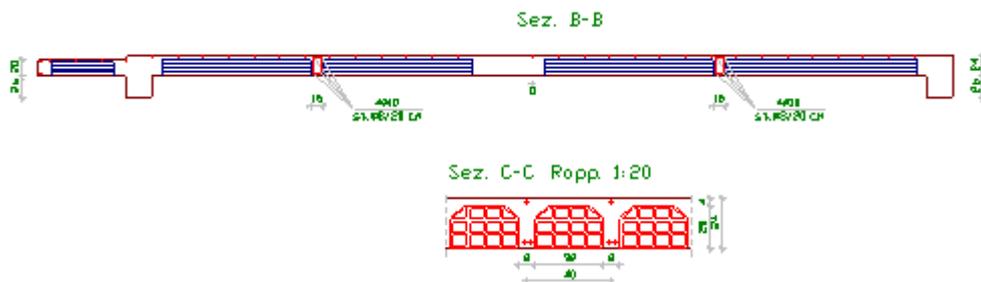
Sezione longitudinale e trasversale del solaio.
